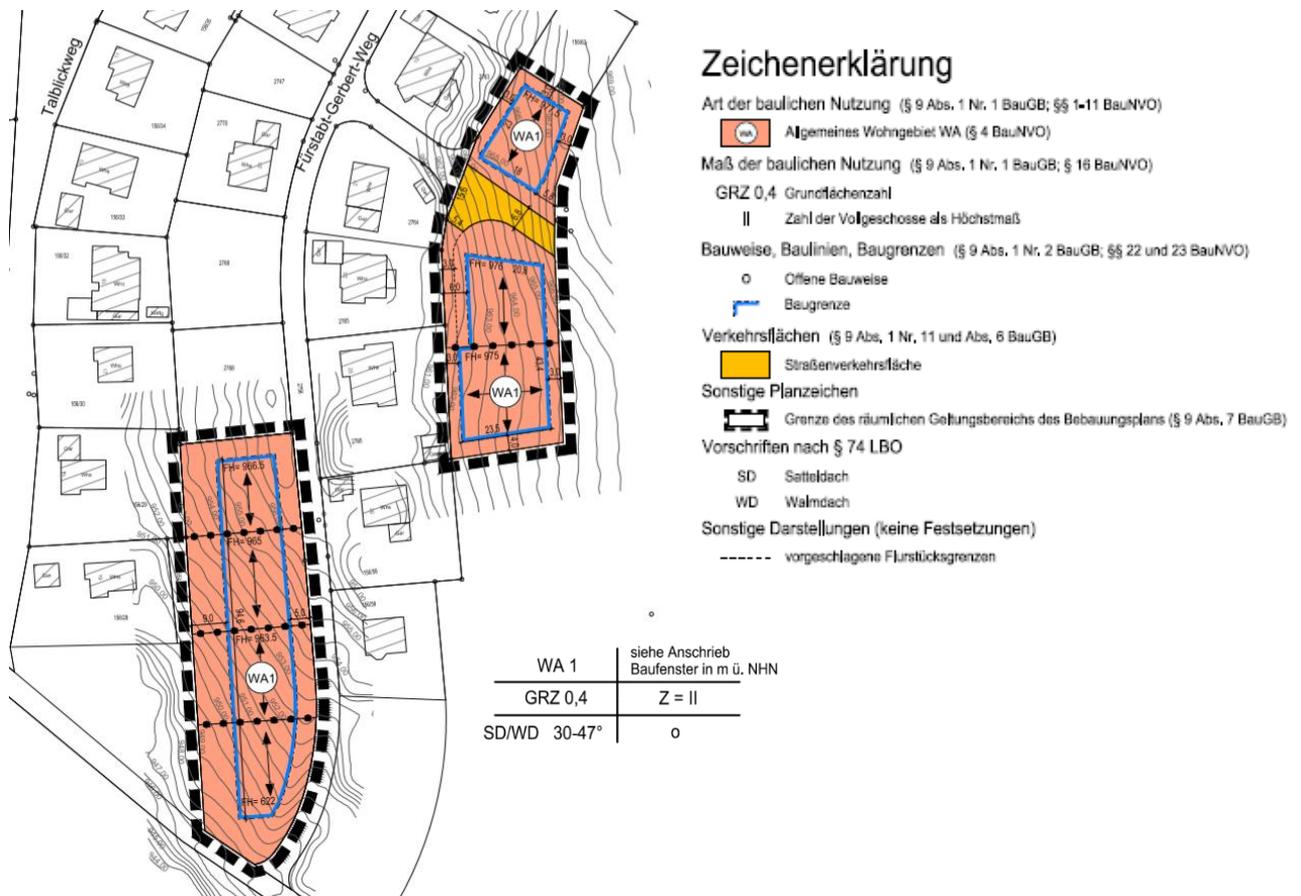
Ausschnitt aus der geplanten Bebauungsplanänderung (Quelle: fsp Stadtplanung)
